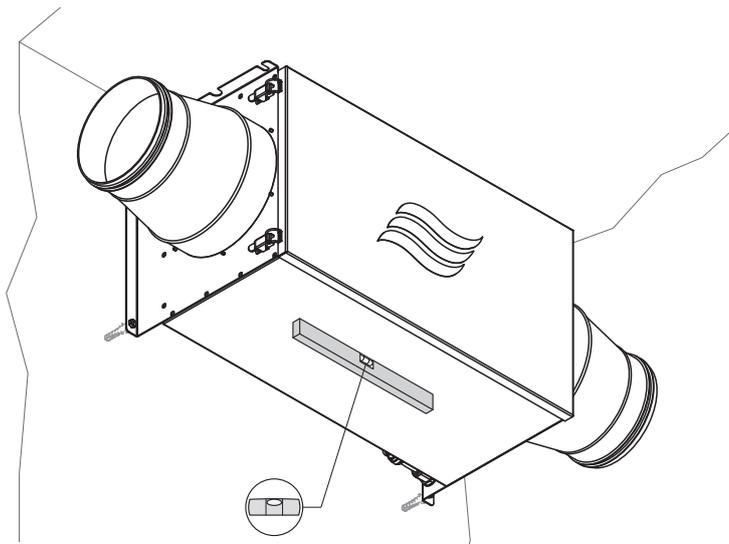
Ajuster le kit de prémontage et serrer les vis
